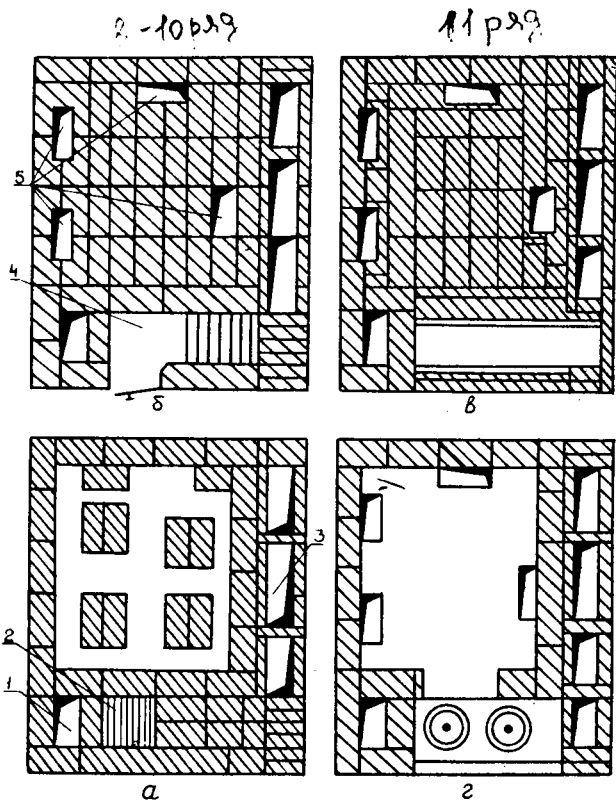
Кладка печи № 2 с 7-го по 12-й ряд: а — 7-й ряд; б — 8—10-й ряды; в — 11-й ряд; г — 12-й ряд; 1 — канал из тепловой камеры под зимнюю задвижку; 2 — колосники; 3 — дымообороты обогревательного щитка; 4 — топливник; 5 — шурупы
